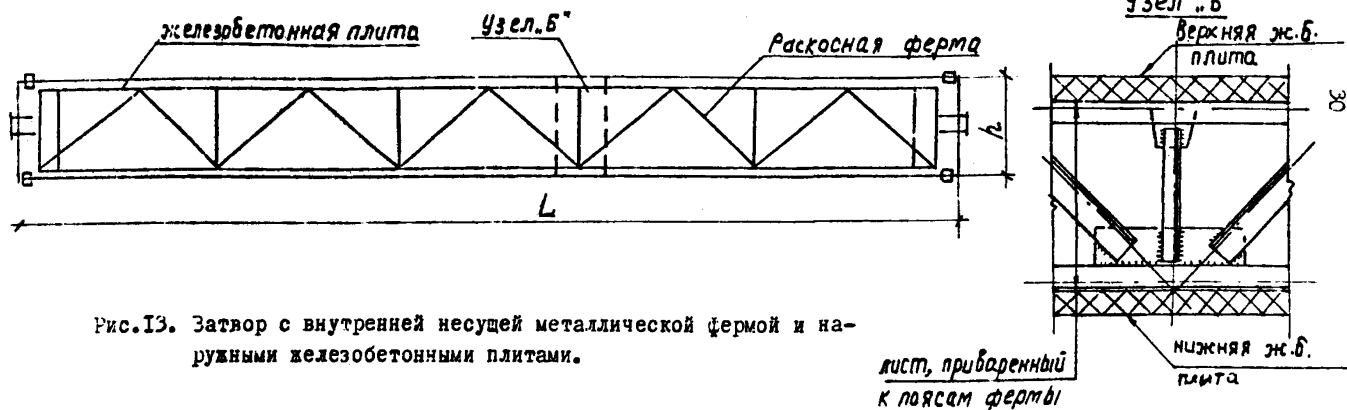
Затвор с внутренней несущей металлической фермой и наружными железобетонными плитами.
